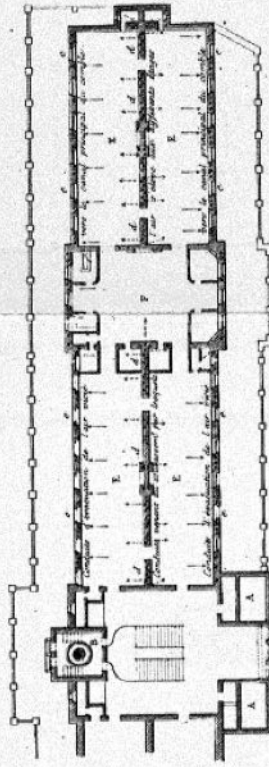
Plan du 1er étage montrant le système de conduits d'air ascendant et d'air vicié.
